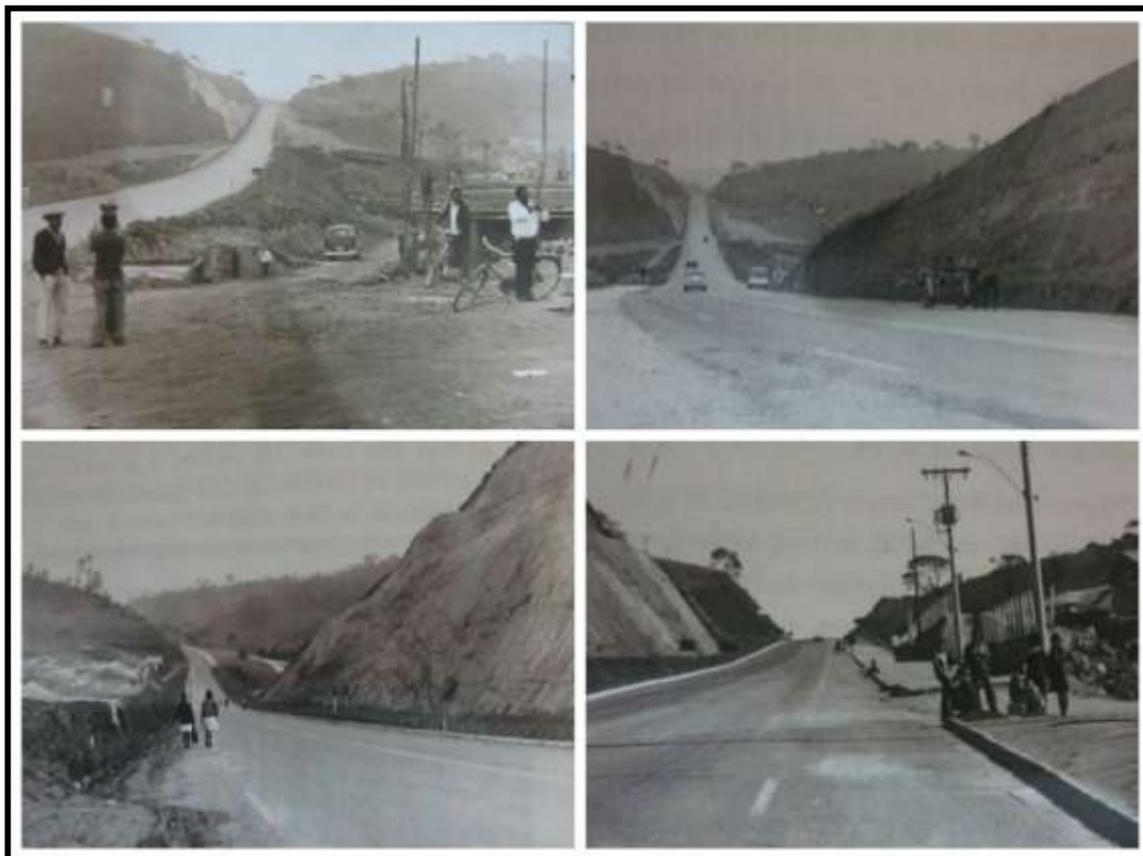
Avenida Castelo Branco passando alguns trechos do bairro Santo Antônio.
